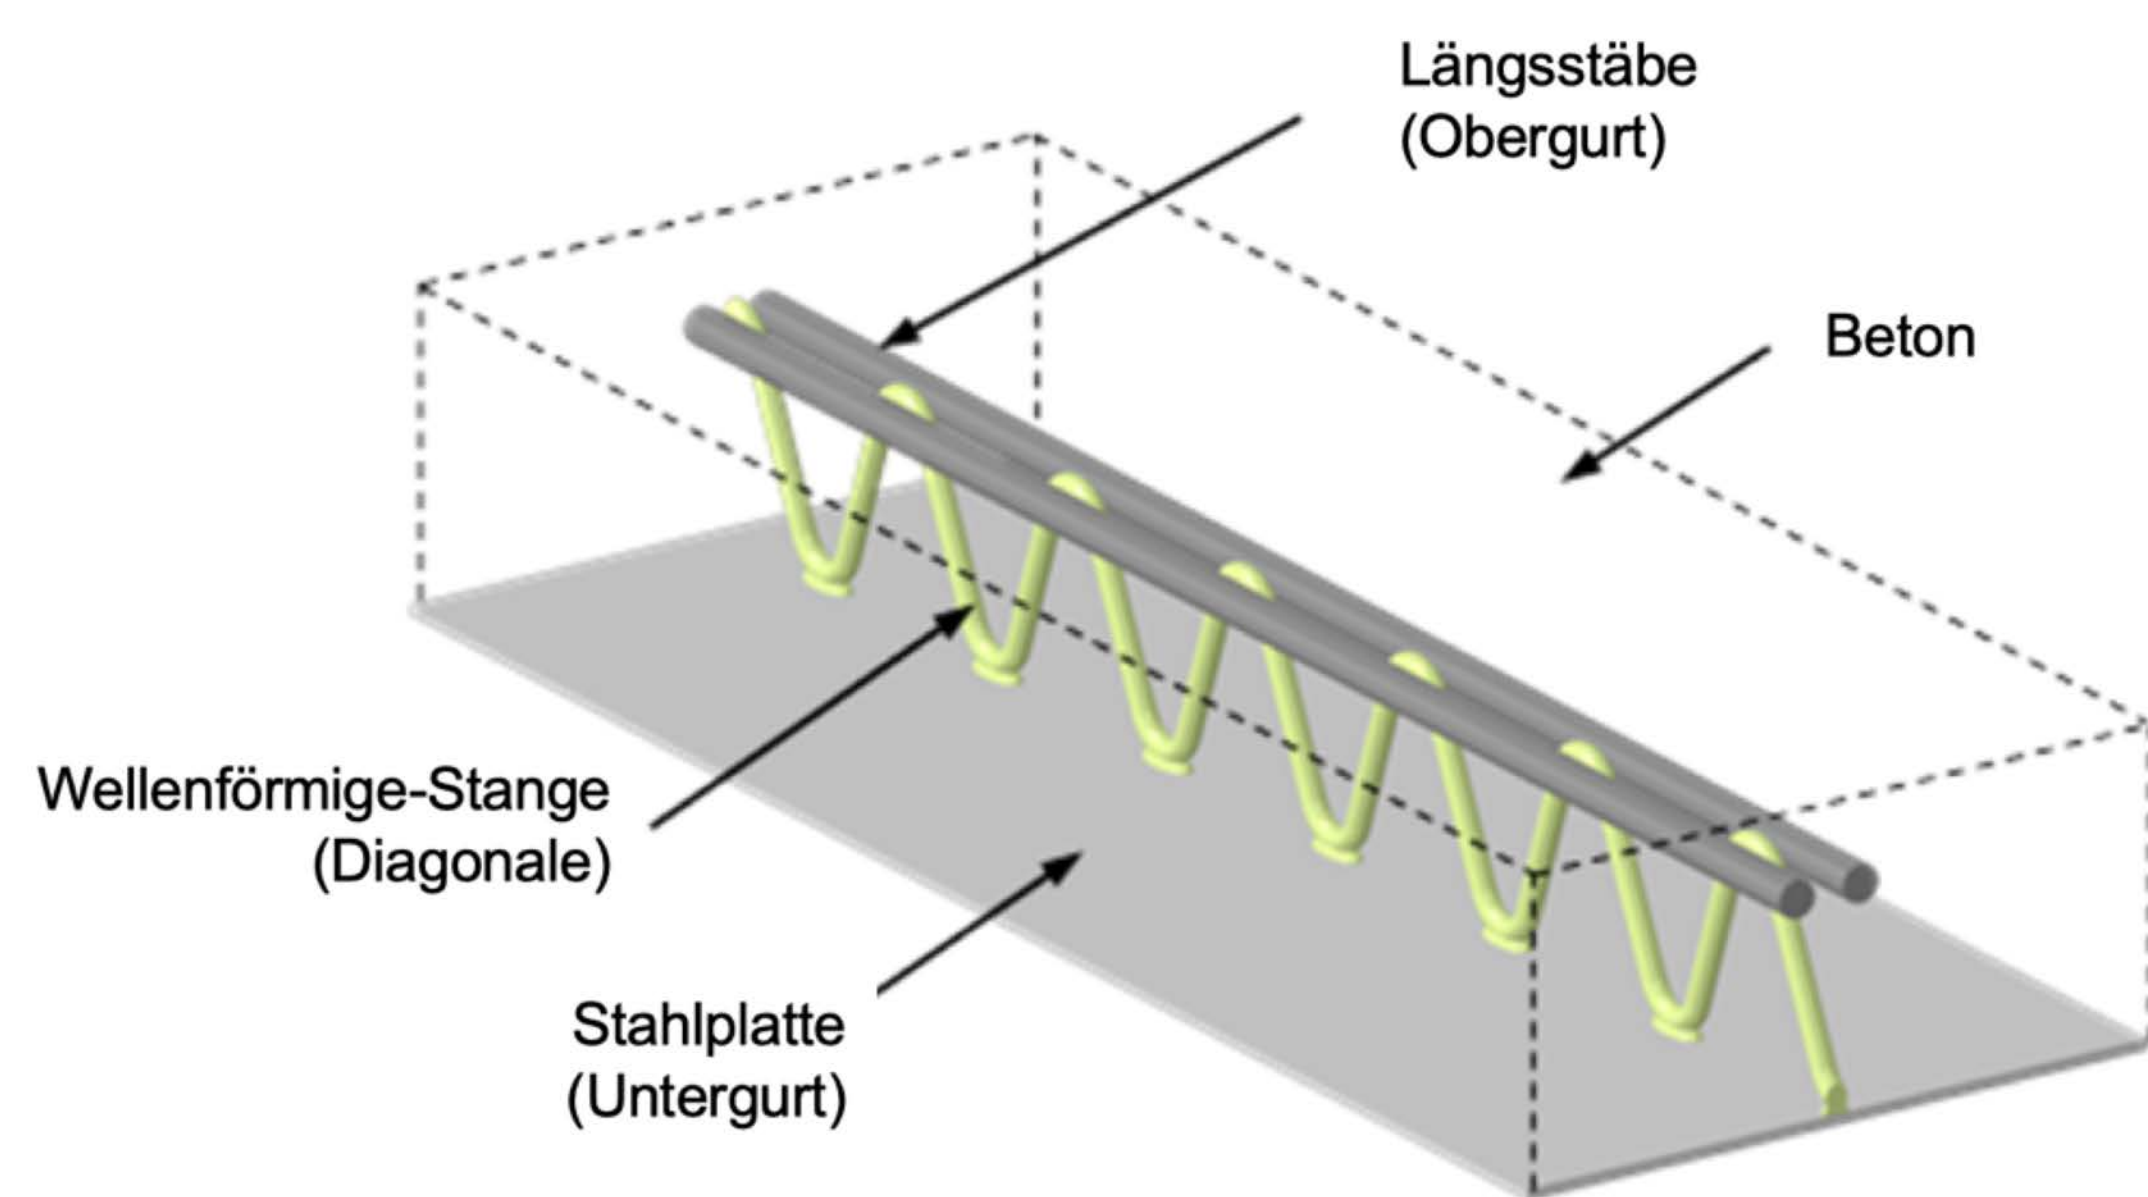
Schema eines Stahlfachwerk-Beton-Verbundträgers (Quelle: Dr. Valentino Vigneri)
